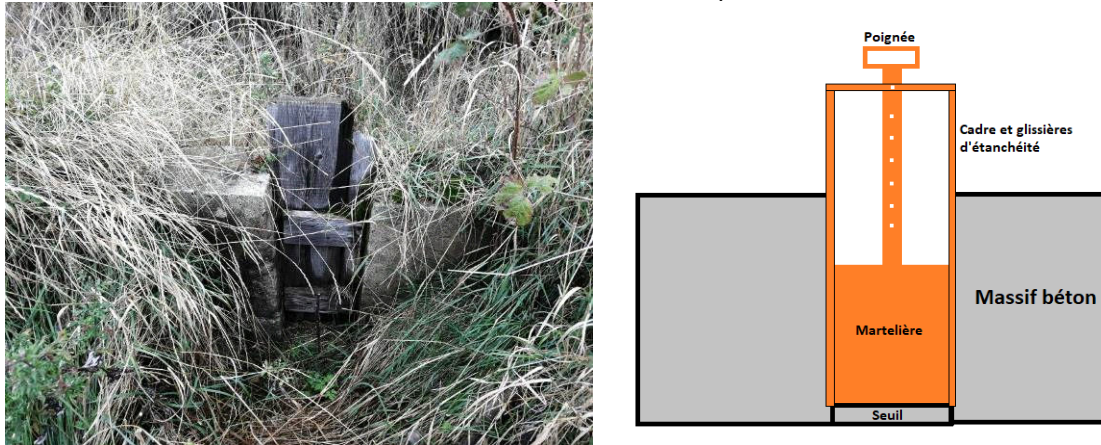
Exemple d'ouvrage de prise d'eau sur les canaux
